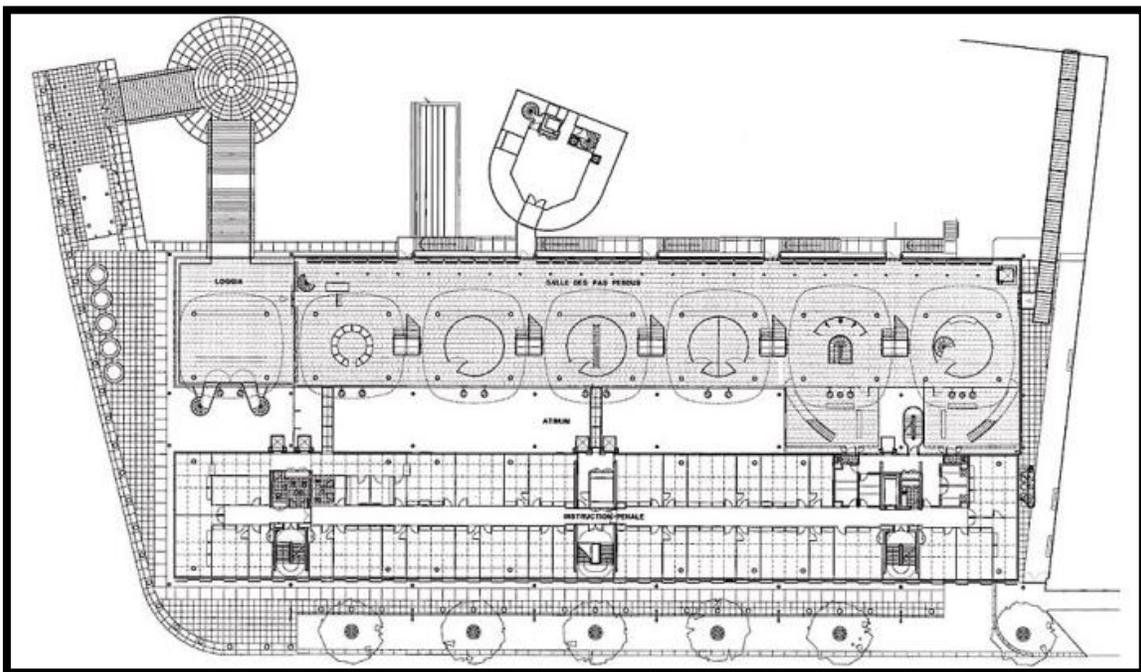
Planta baja Tribunales de Justicia de Burdeos. S/E.
